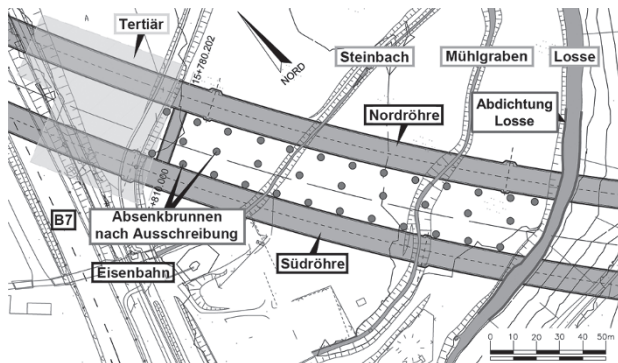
Lageplan Tunnel Hirschhagen, Detail
